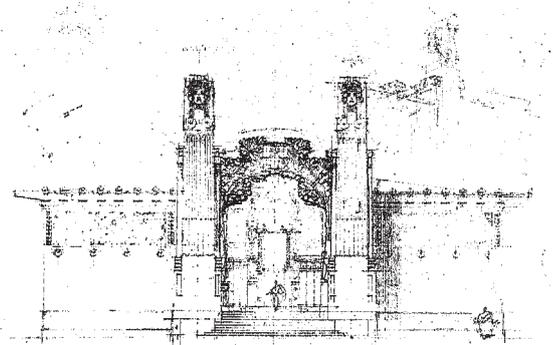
Primer boceto para el edificio de la Sección Viena (1897) Fachada hacia la Ringstrasse. Josef M. Olbrich.
